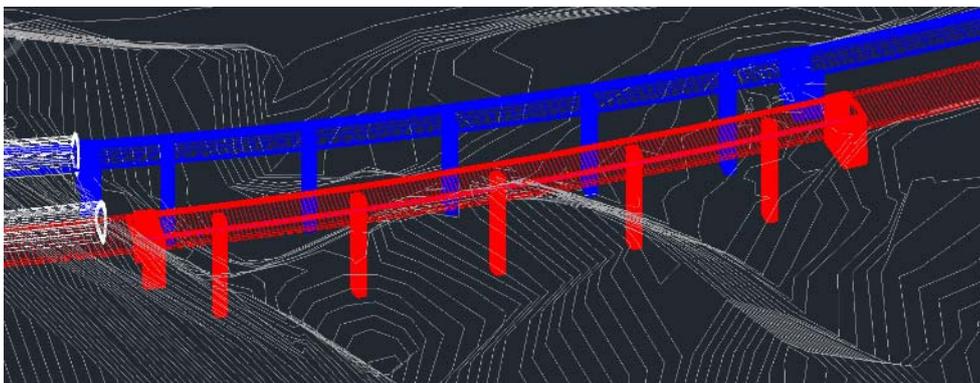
Prikaz pogleda na vijadukt Šum – varijanta 1 (plavo – postojeći, crveno – planirani)
